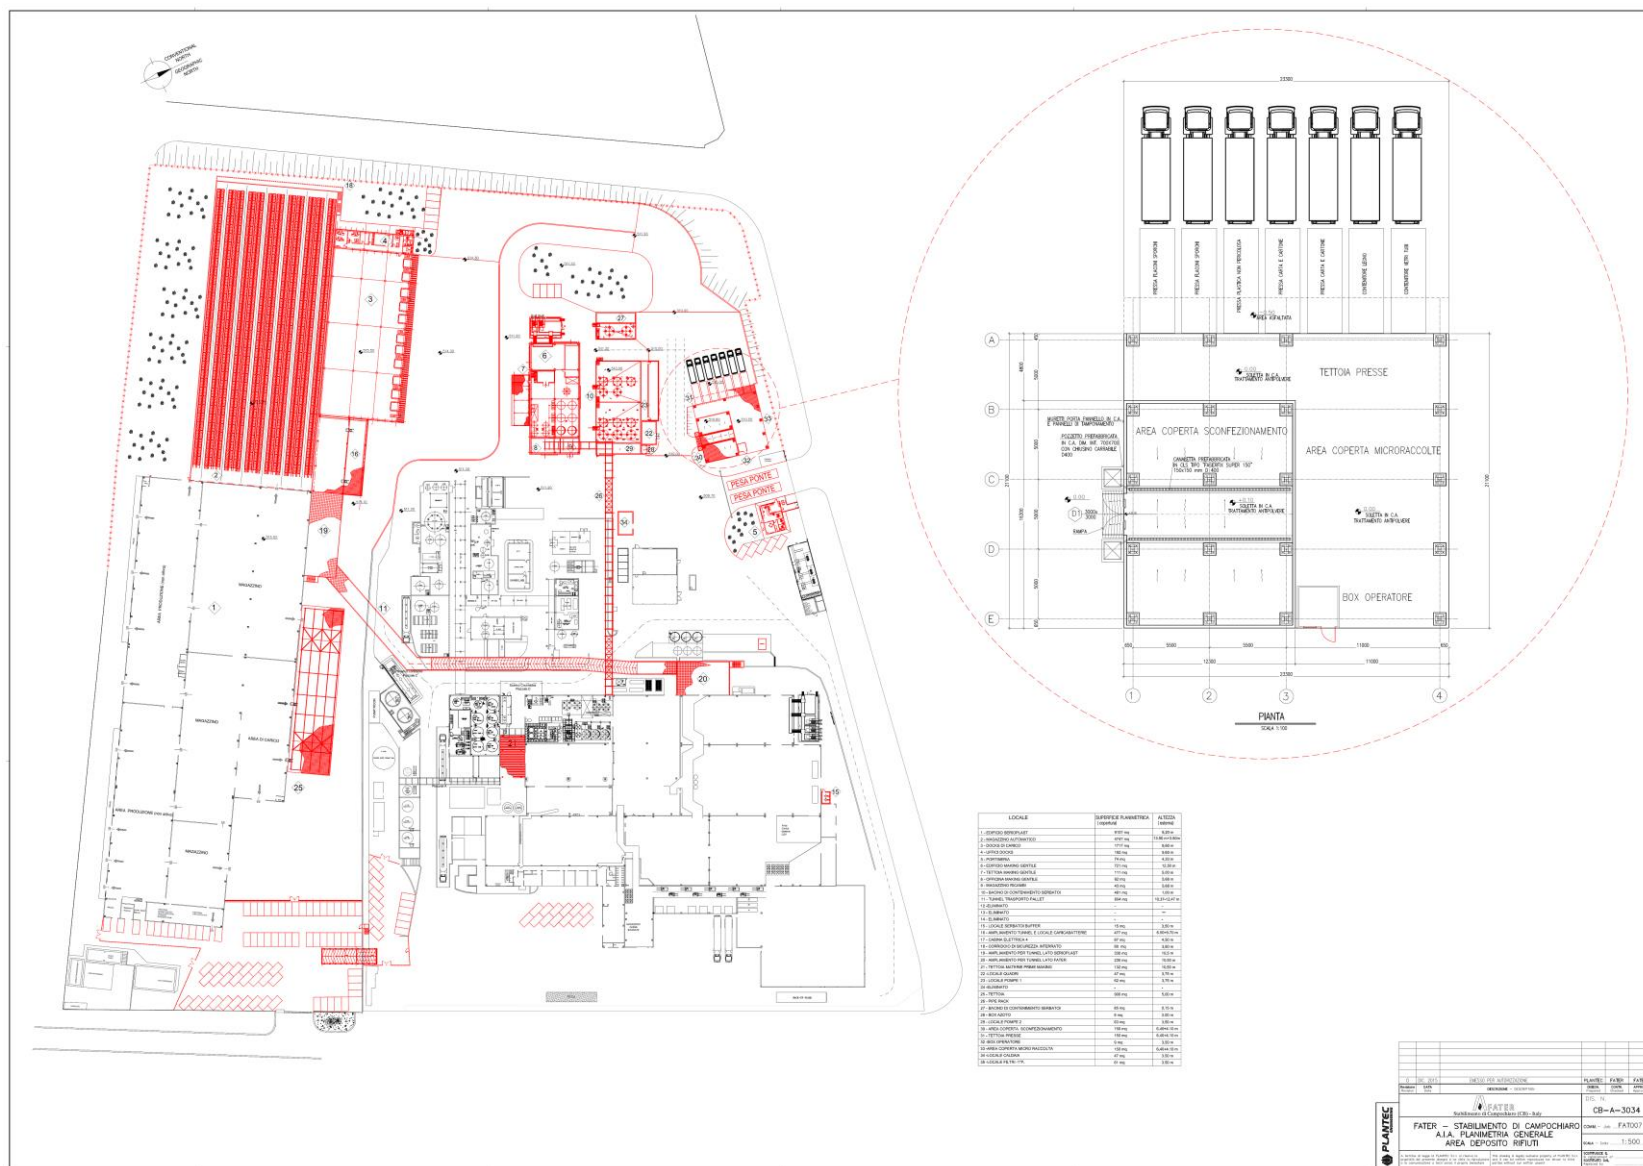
planimetria generale di stabilimento con indicazione delle aree dedicate al deposito temporaneo di rifiuti: assetto "post operam"
